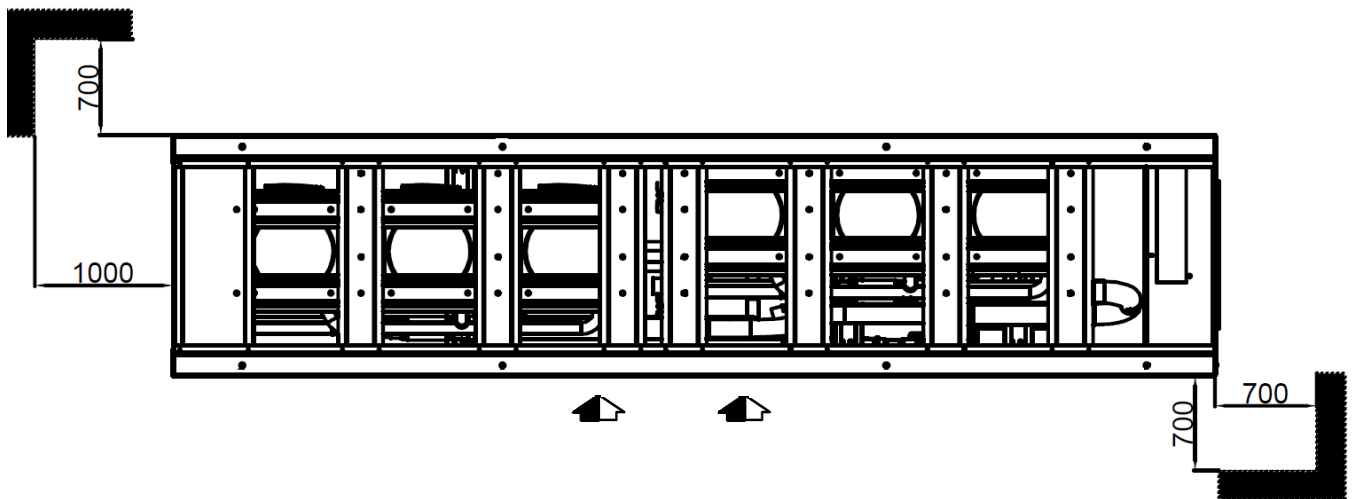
Mindestplatzbedarf [mm] für Plattform-4-Maschinen
